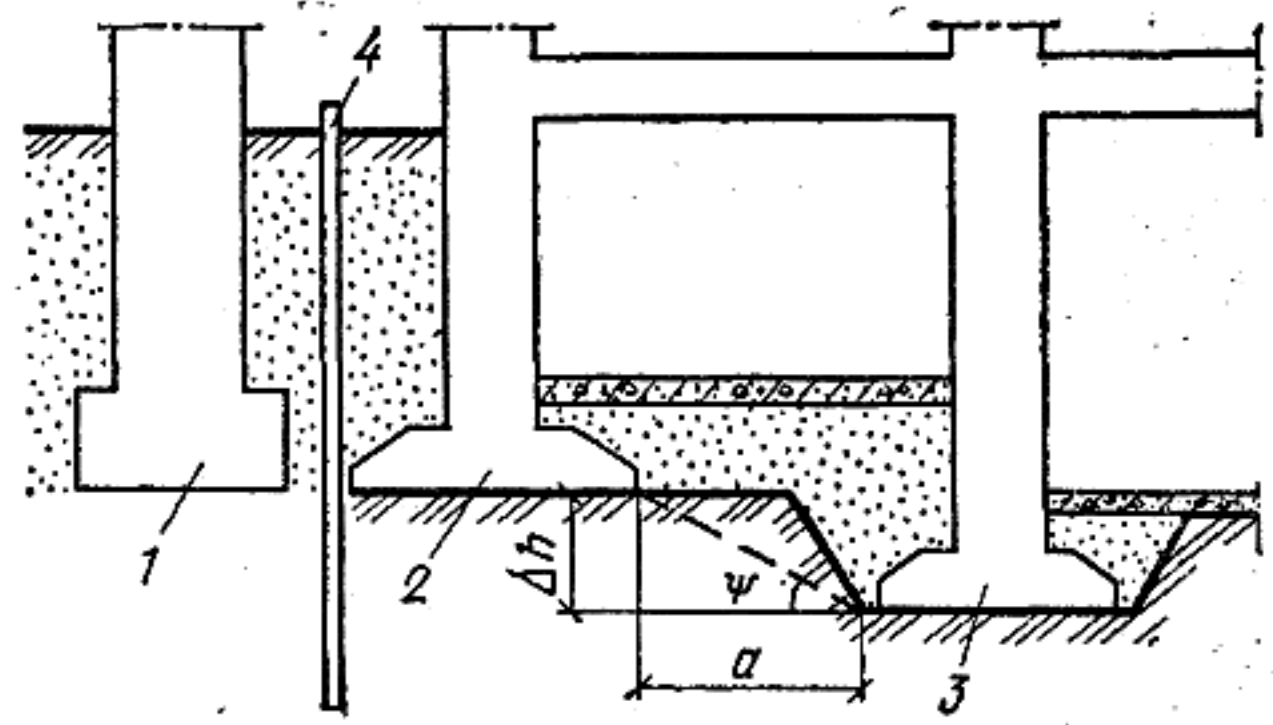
Схема защиты существующего здания от дополнительных осадков при возведении рядом нового здания с большей глубиной заложения фундамента
